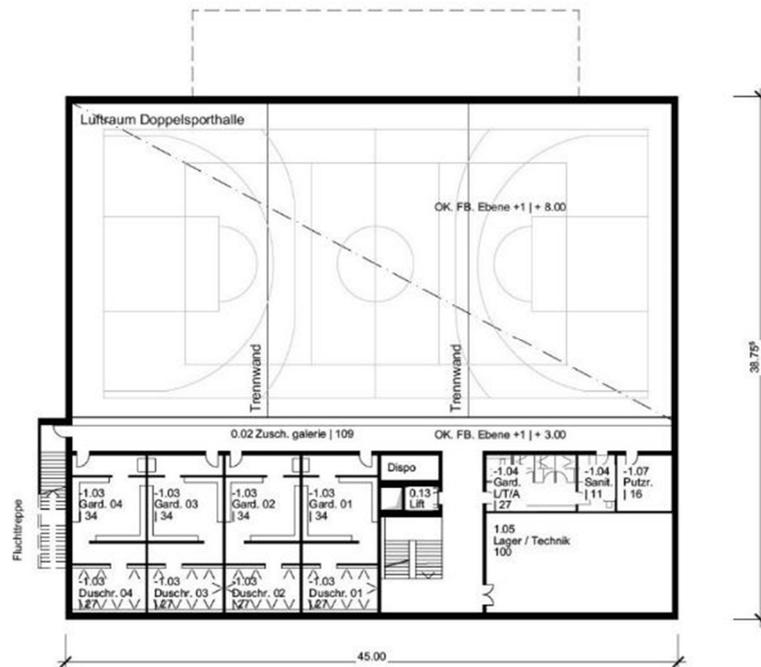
„aufgesetzte“ Doppelsporthalle B | Disposition 2 - Grundriss 1.Obergeschoss
